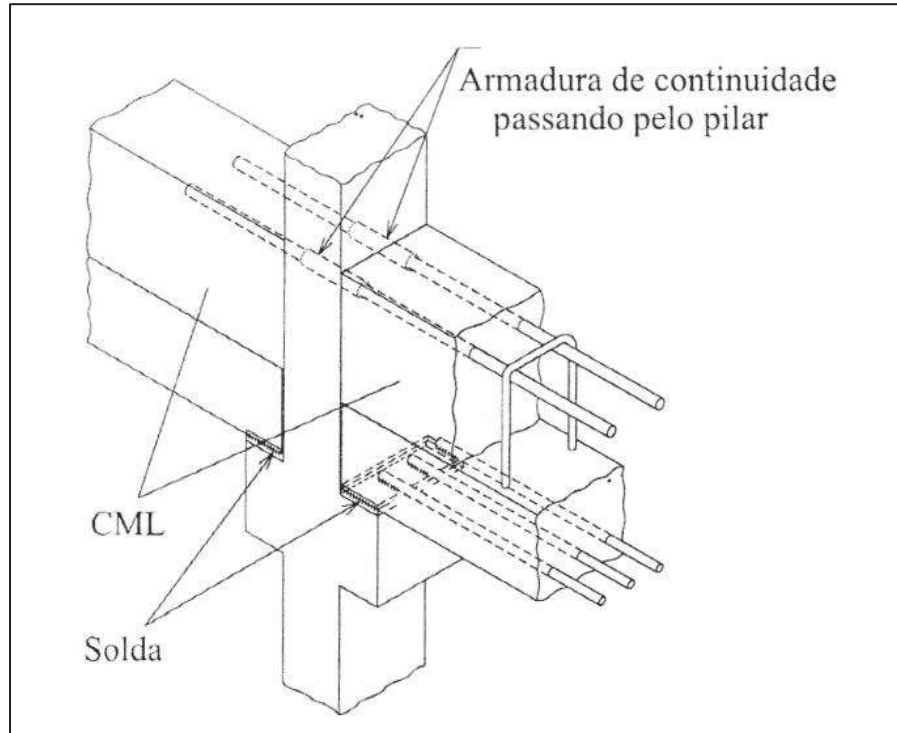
Exemplo Ligação Rígida em pré-fabricados.
